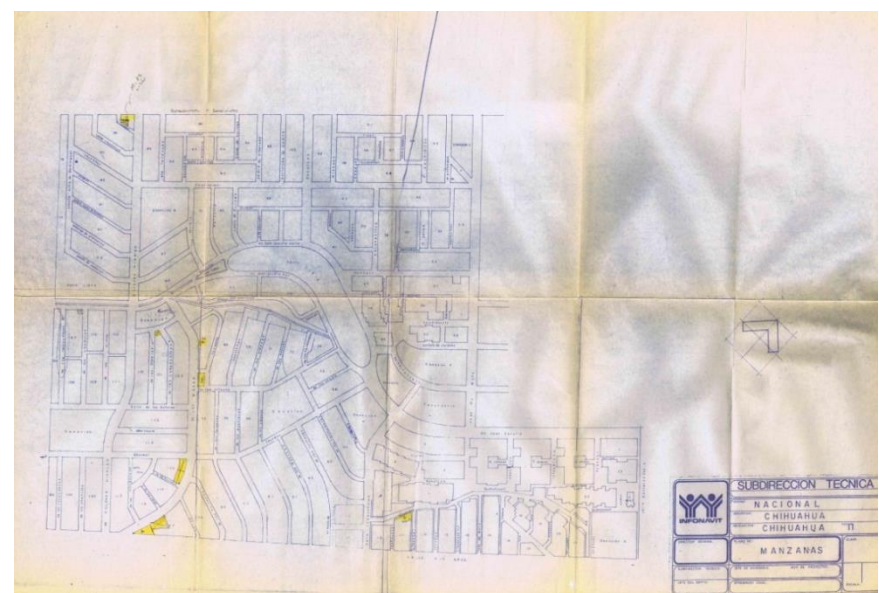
Copia del plano original del conjunto habitacional de INFONAVIT Los Mezquites, 1989. Fuente: INONAVIT.
